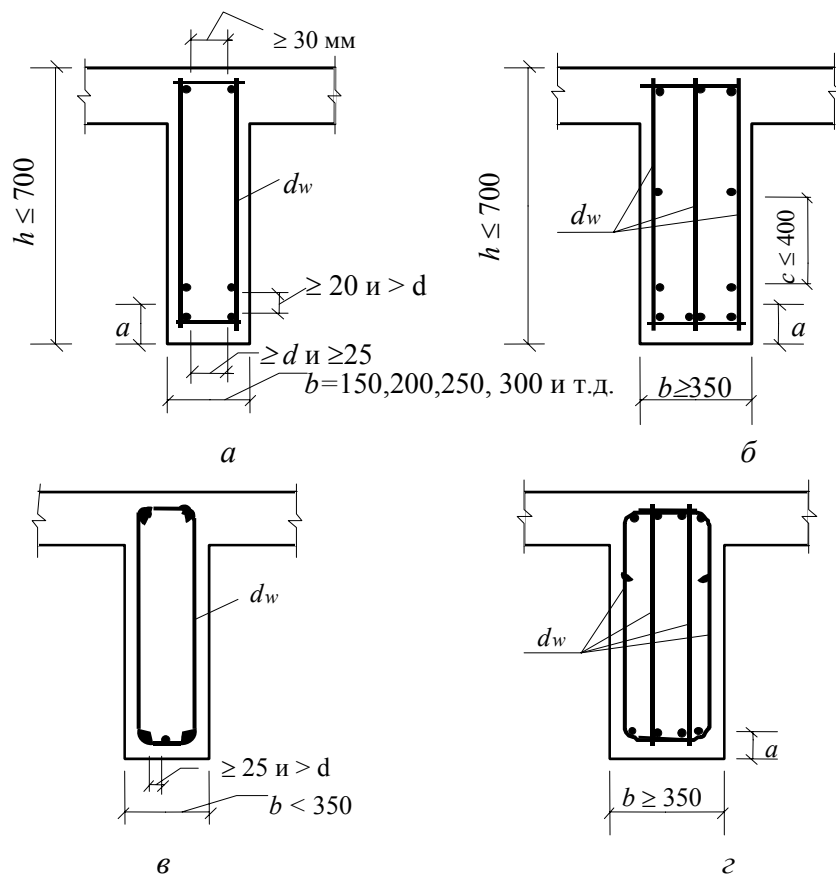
Розміщення арматури в поперечному перерізі балок:
